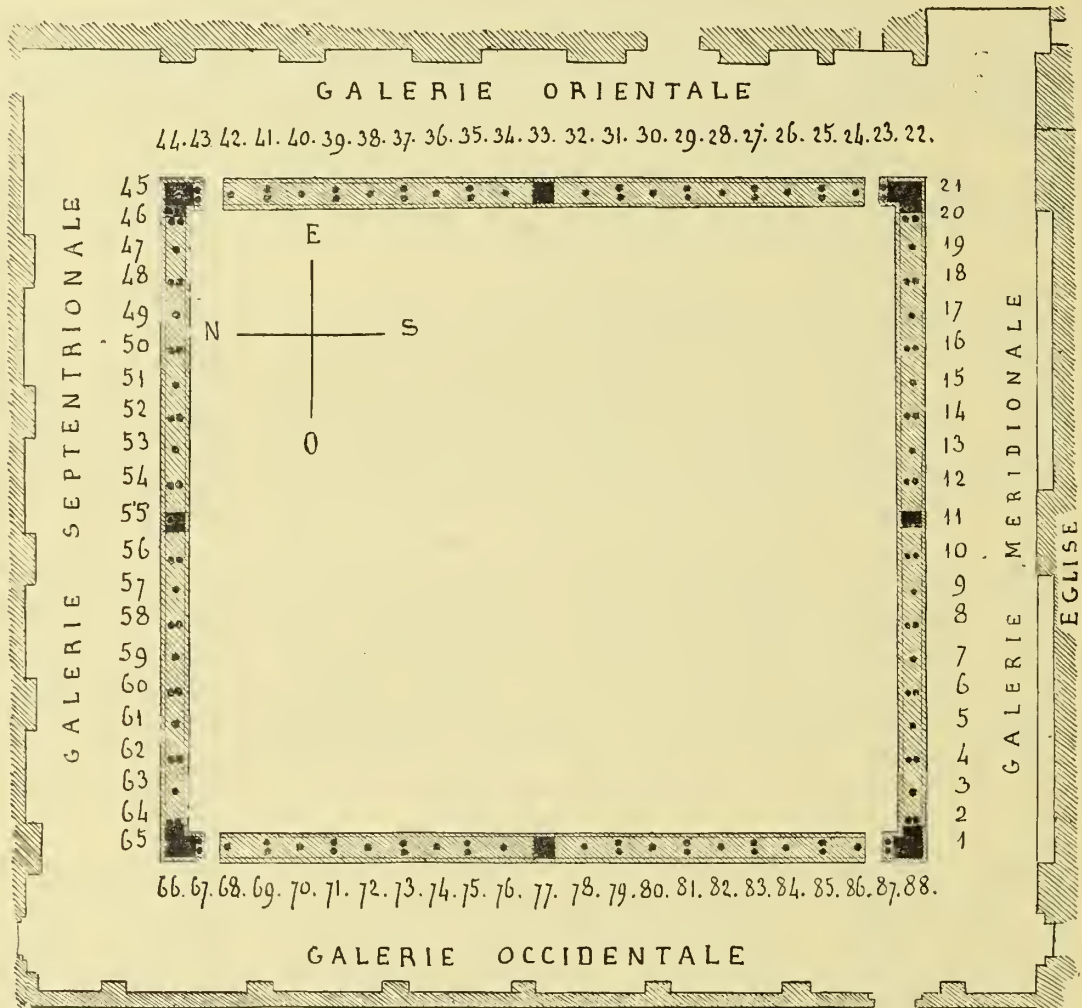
PLAN DES CLOITRES DE MOISSAC
